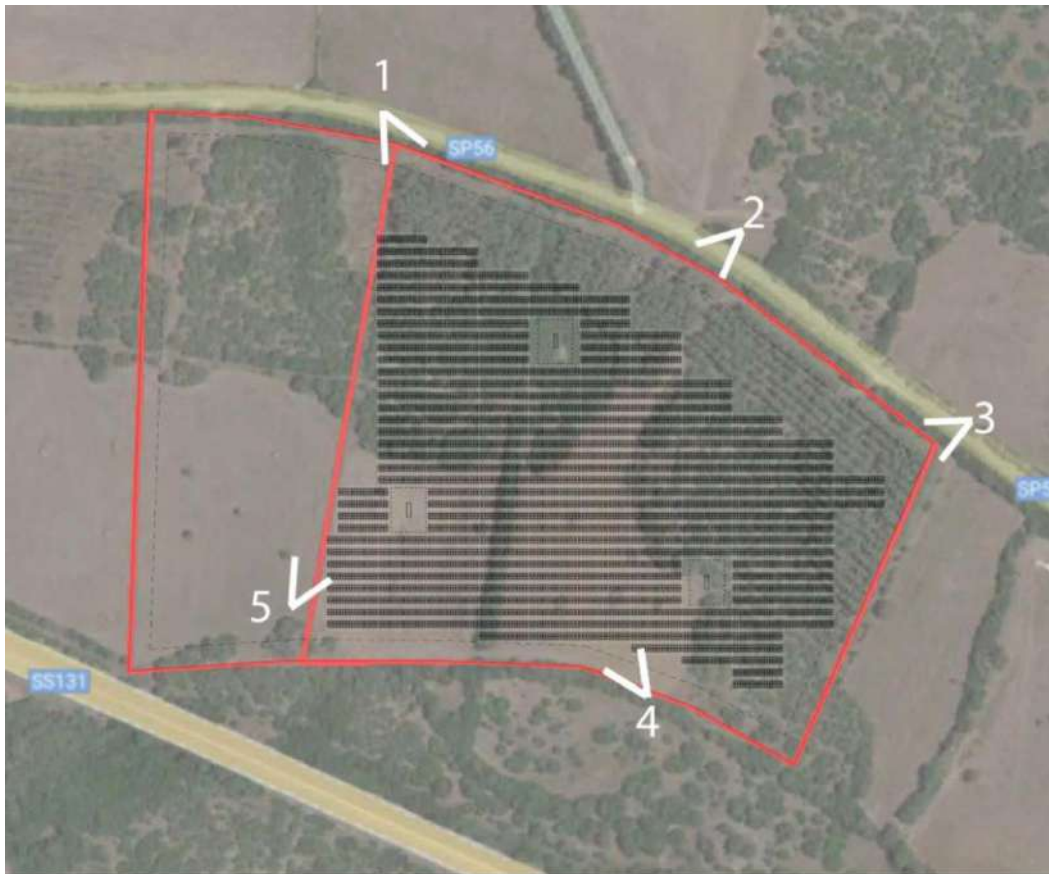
Disposizione planimetrica delle strutture in progetto e punti di scatto
